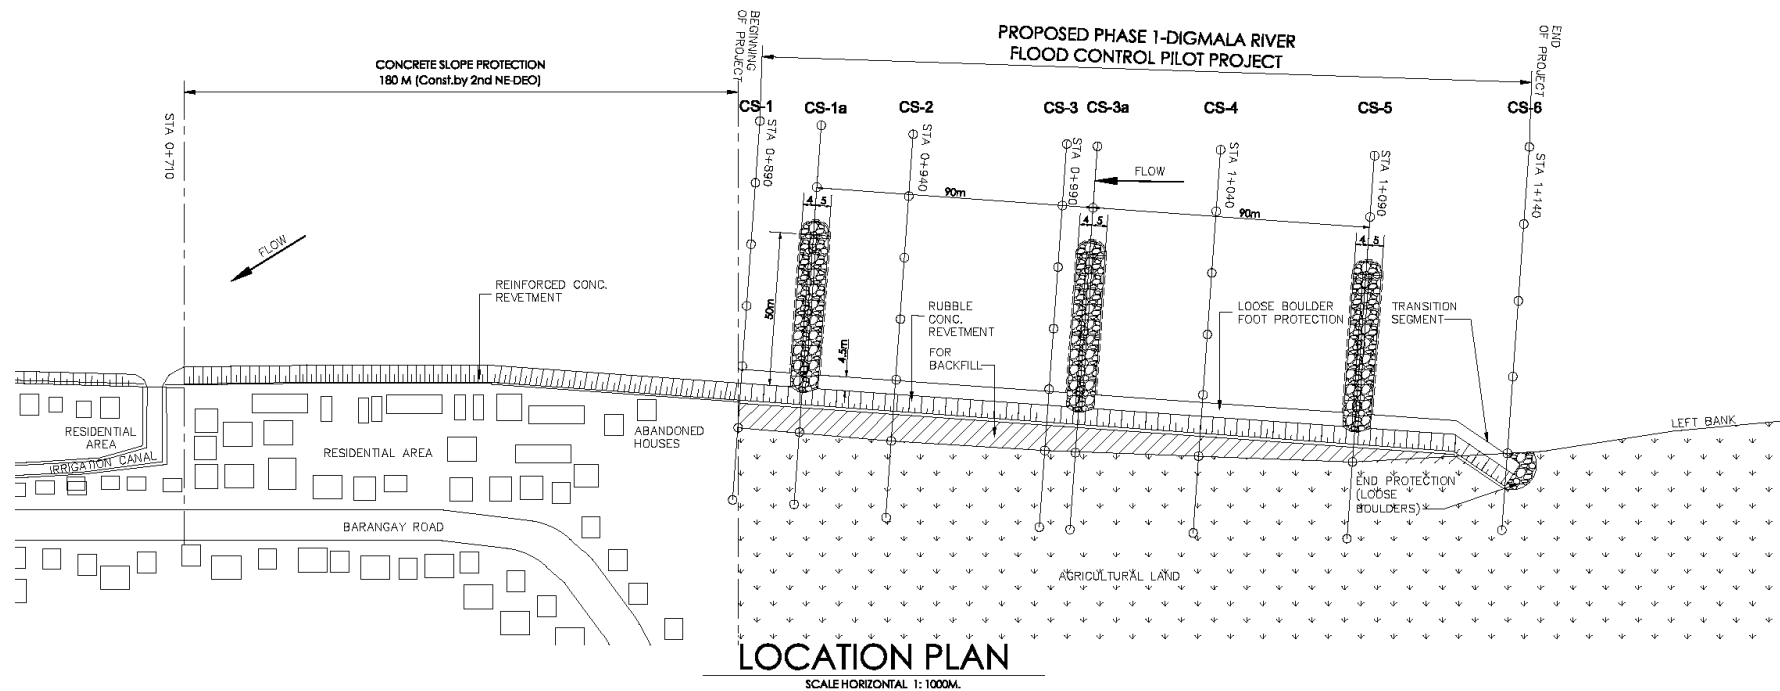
ディグマラ川堤防・護岸. 水制全体平面図
